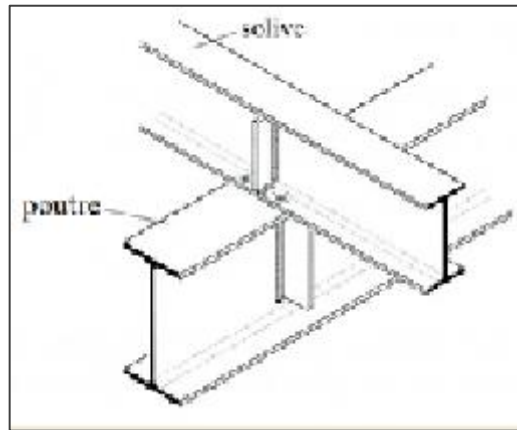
Assemblage d'une solive continue sur une poutre principale
